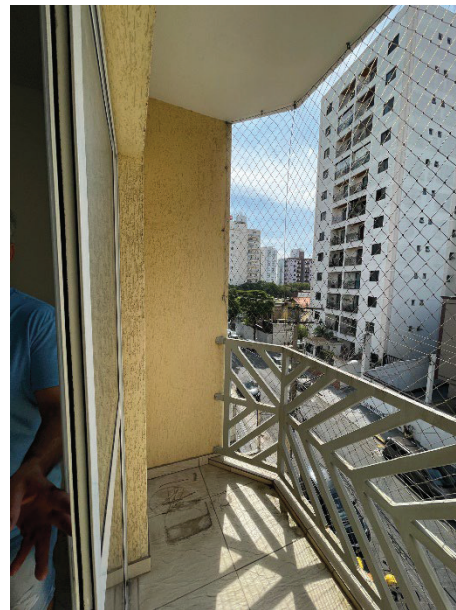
Sacada – Apartamento 31 – 3º Pavimento – Avaliando
